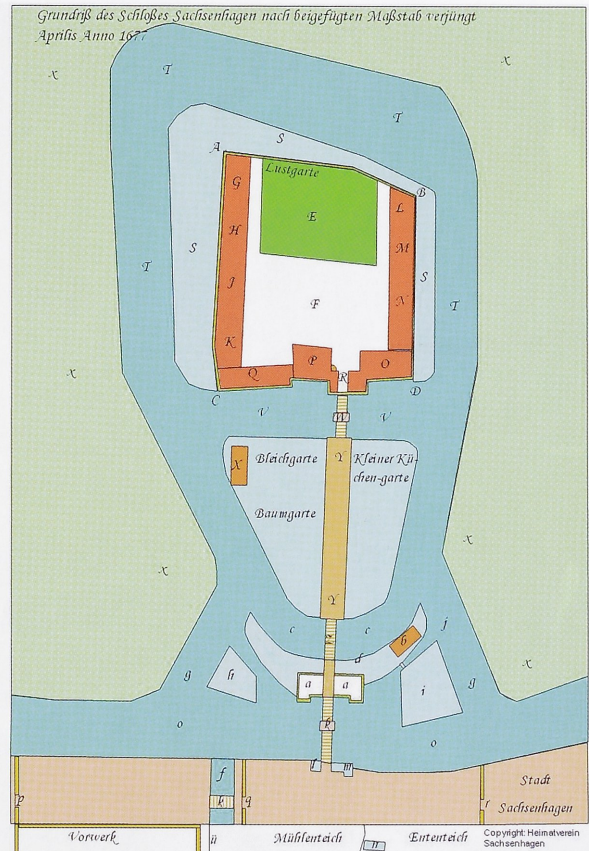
Grundriss der Schlossanlage erstellt auf Grundlage des Plans von 1677.
